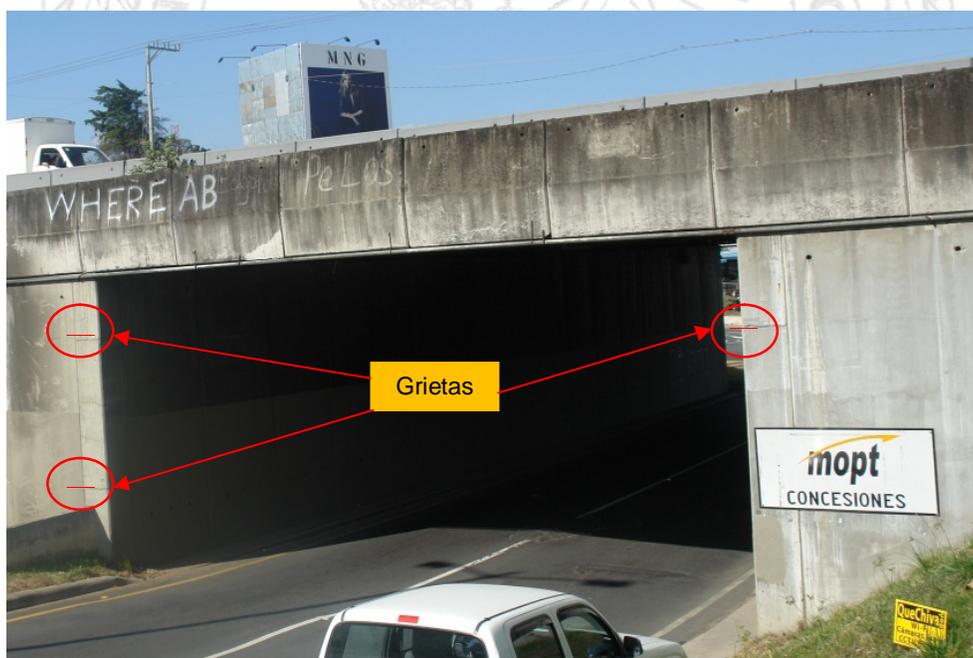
Ubicación de grietas en los extremos de los bastiones de la sección I
